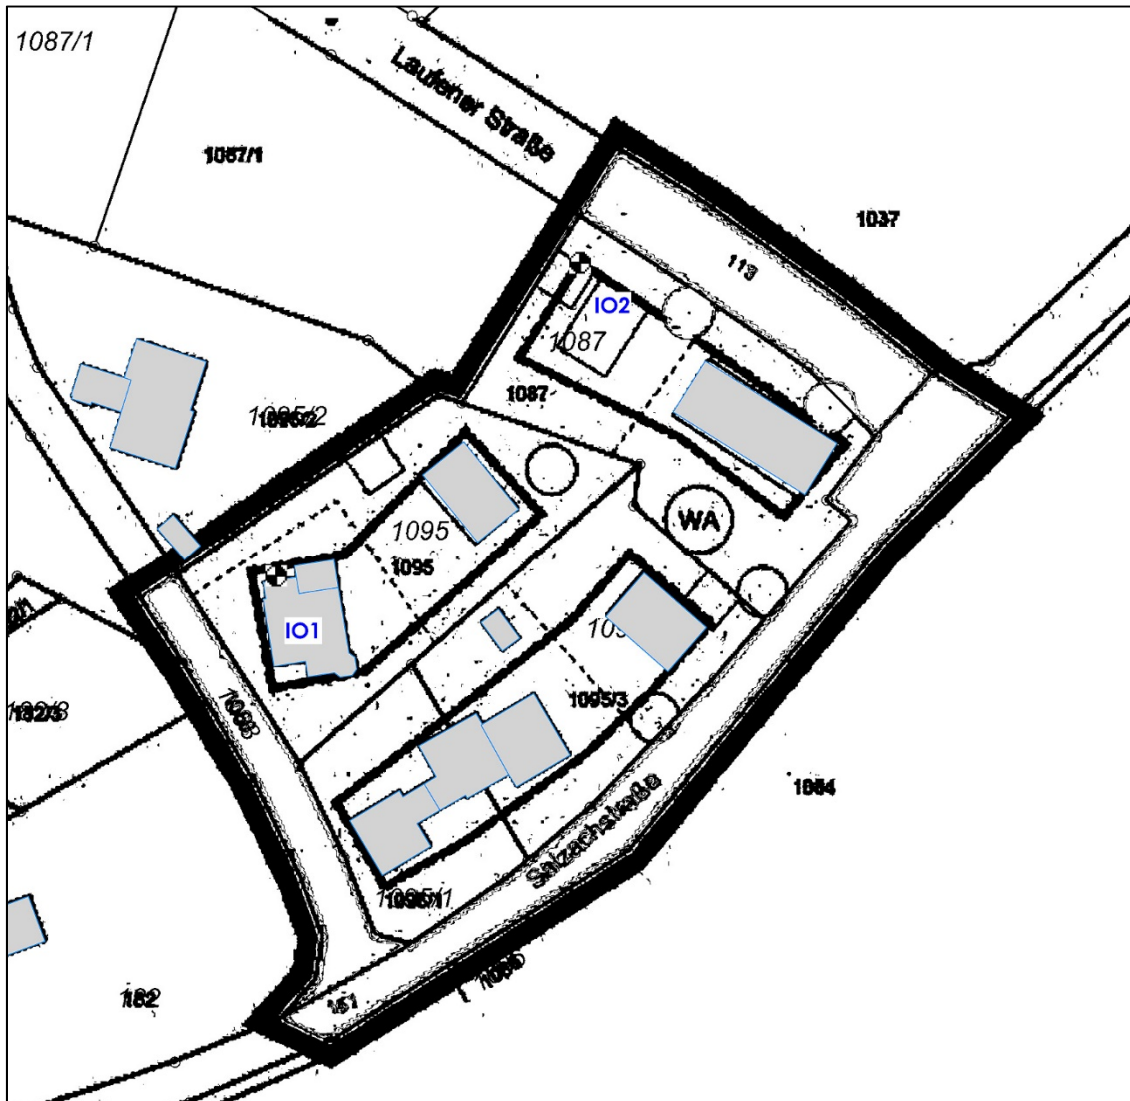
Lageplan mit Darstellung der Immissionsorte (IO)
